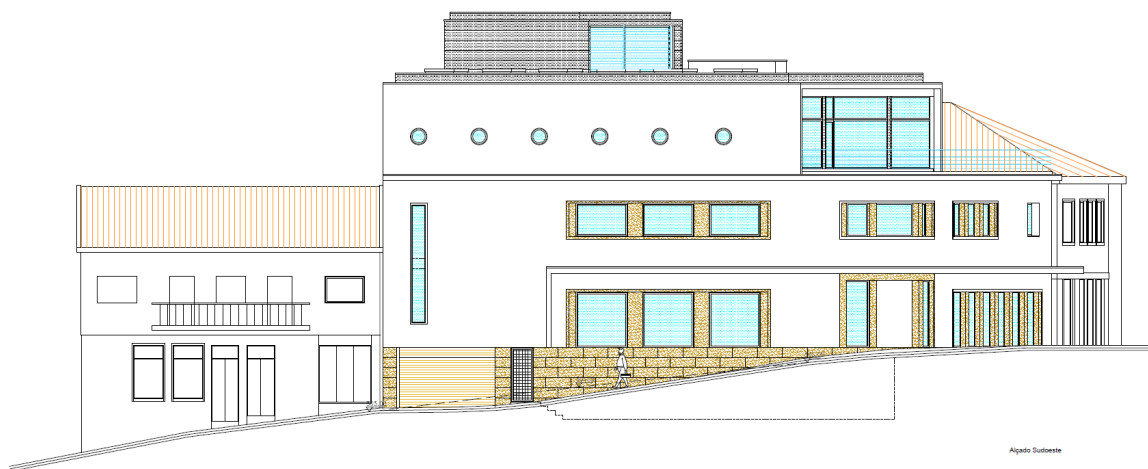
Alçado Sudoeste. Fonte: Corcovado Construções.
